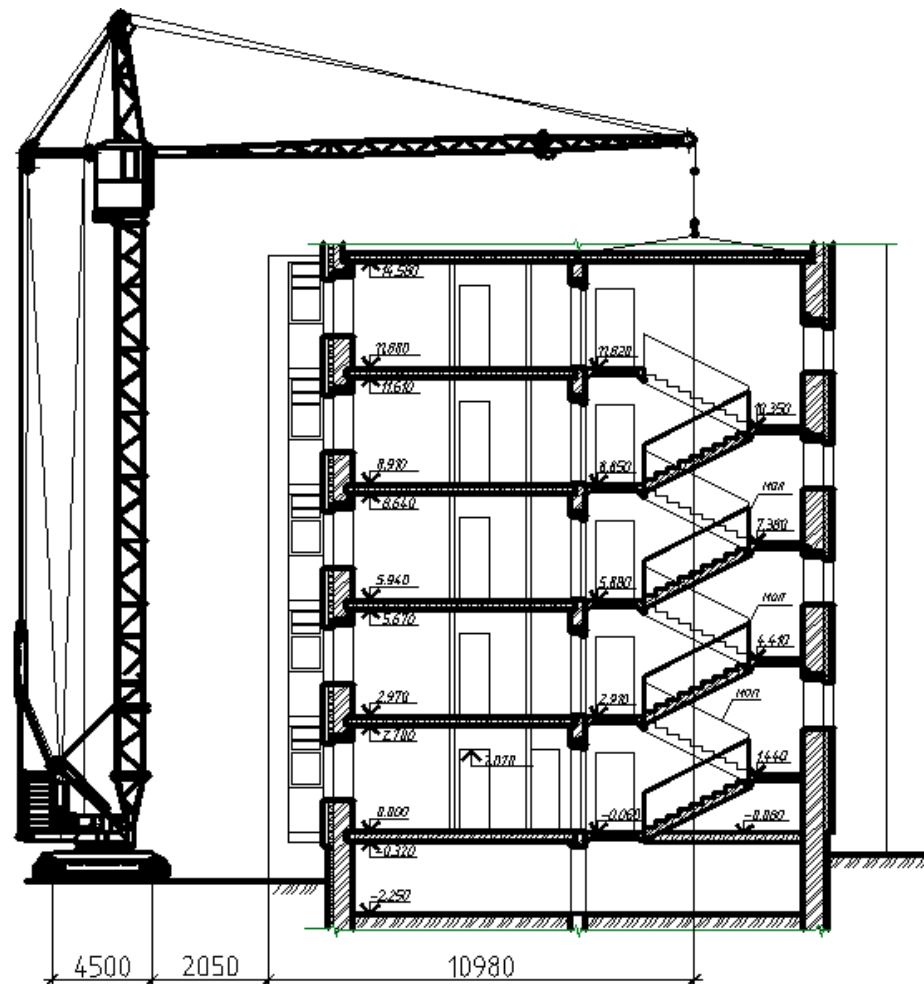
Монтаж плиты перекрытия краном КБ-100.1
